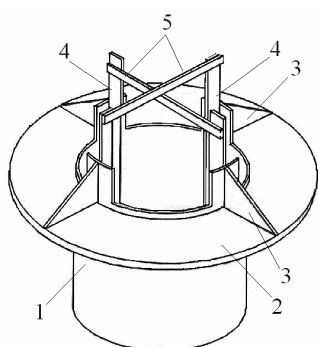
Схема узла соединения безбалочного перекрытия с колонной 1 – колонна; 2 – плита стыкового элемента; 3 – косынка; 4 – ребро жесткости; 5 – связь ребер жесткости
